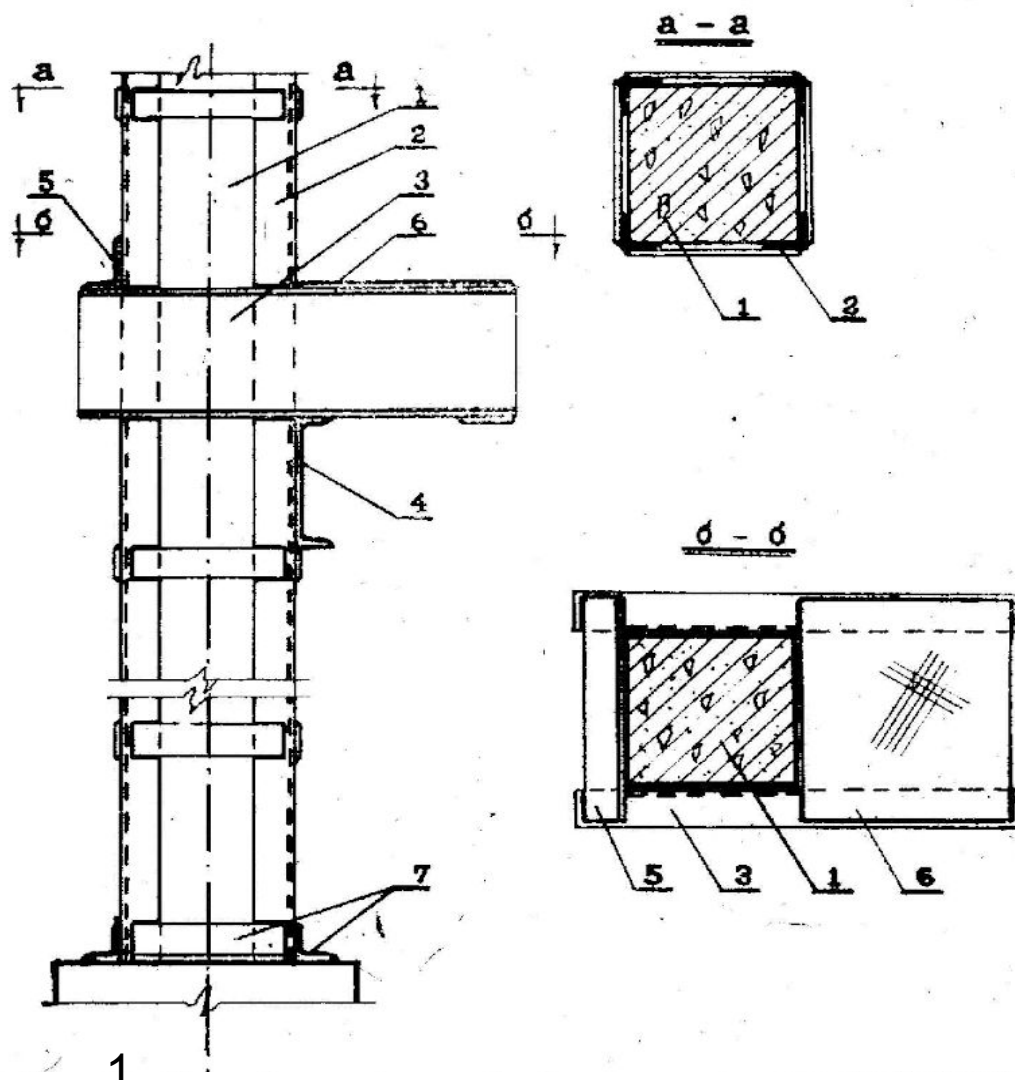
Устройство стальной консоли у железобетонных колонн:
